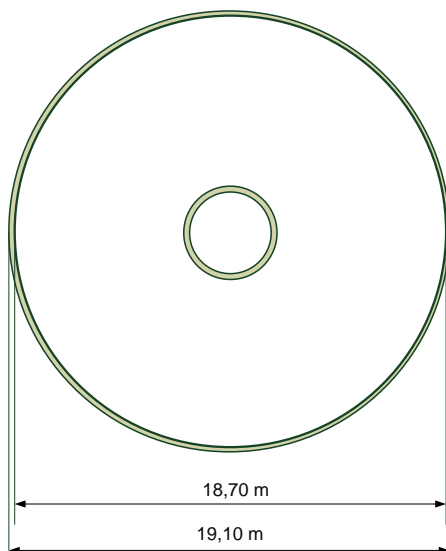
Skizze Grundriss der Regenwasserzisterne
